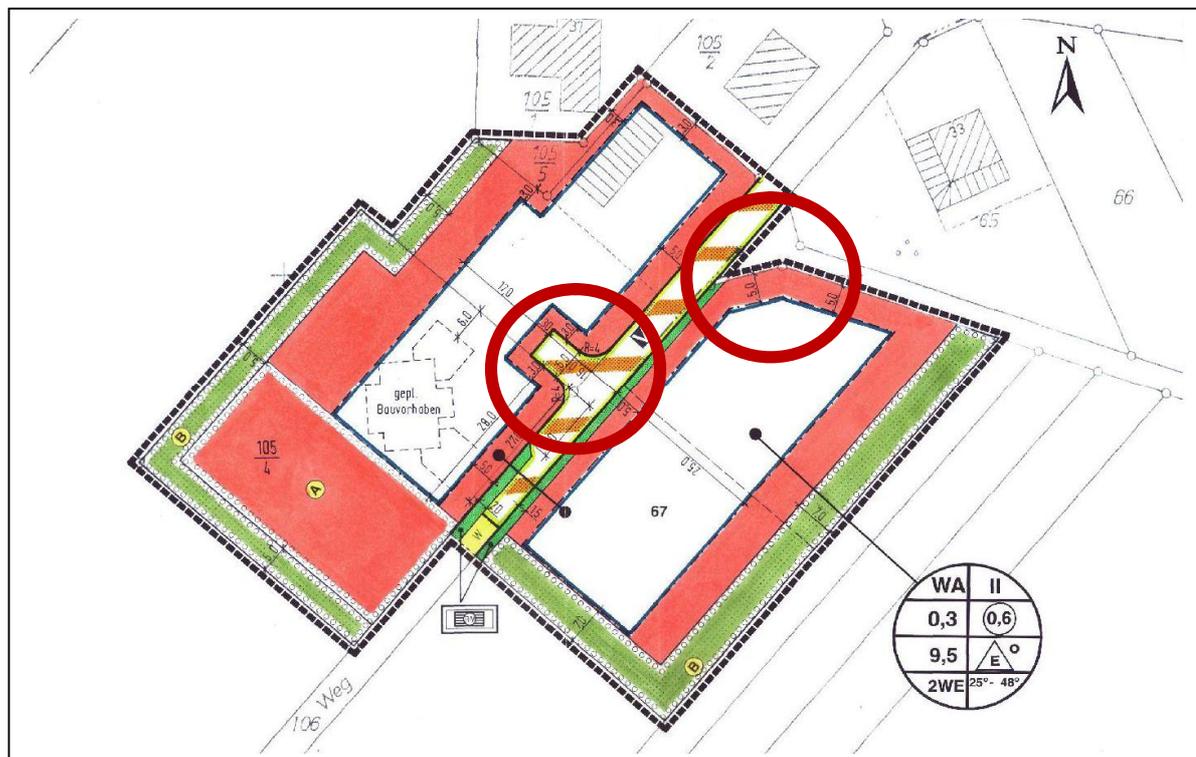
Bereiche mit Änderungen und Anpassungen - unmaßstäblich
